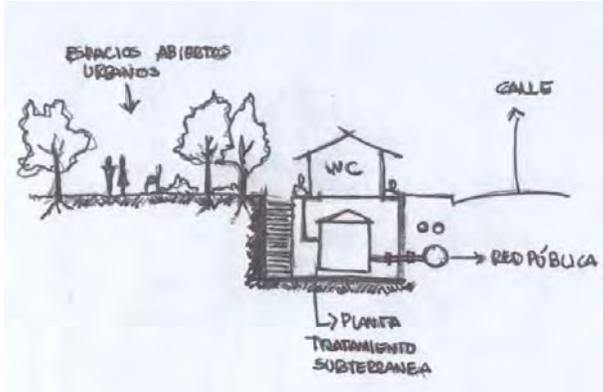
Detalle de dónde ubicar a las plantas de tratamiento
